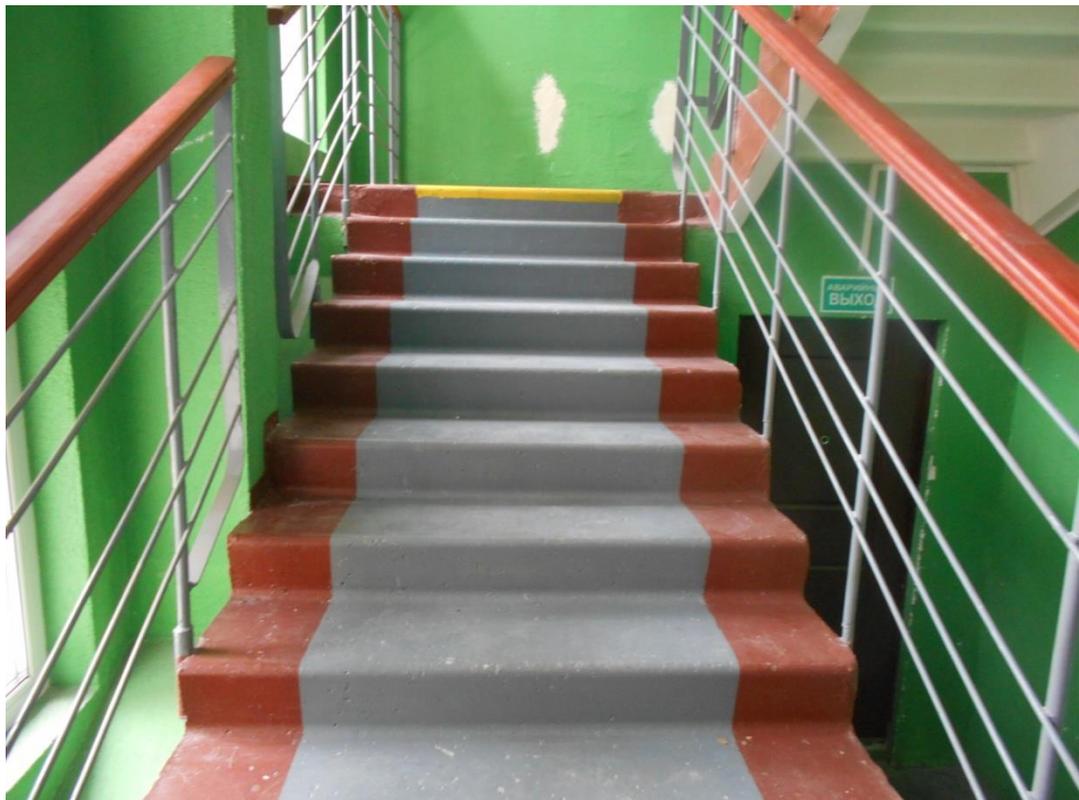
Лестница к эвакуационному выходу. На плане №26.
